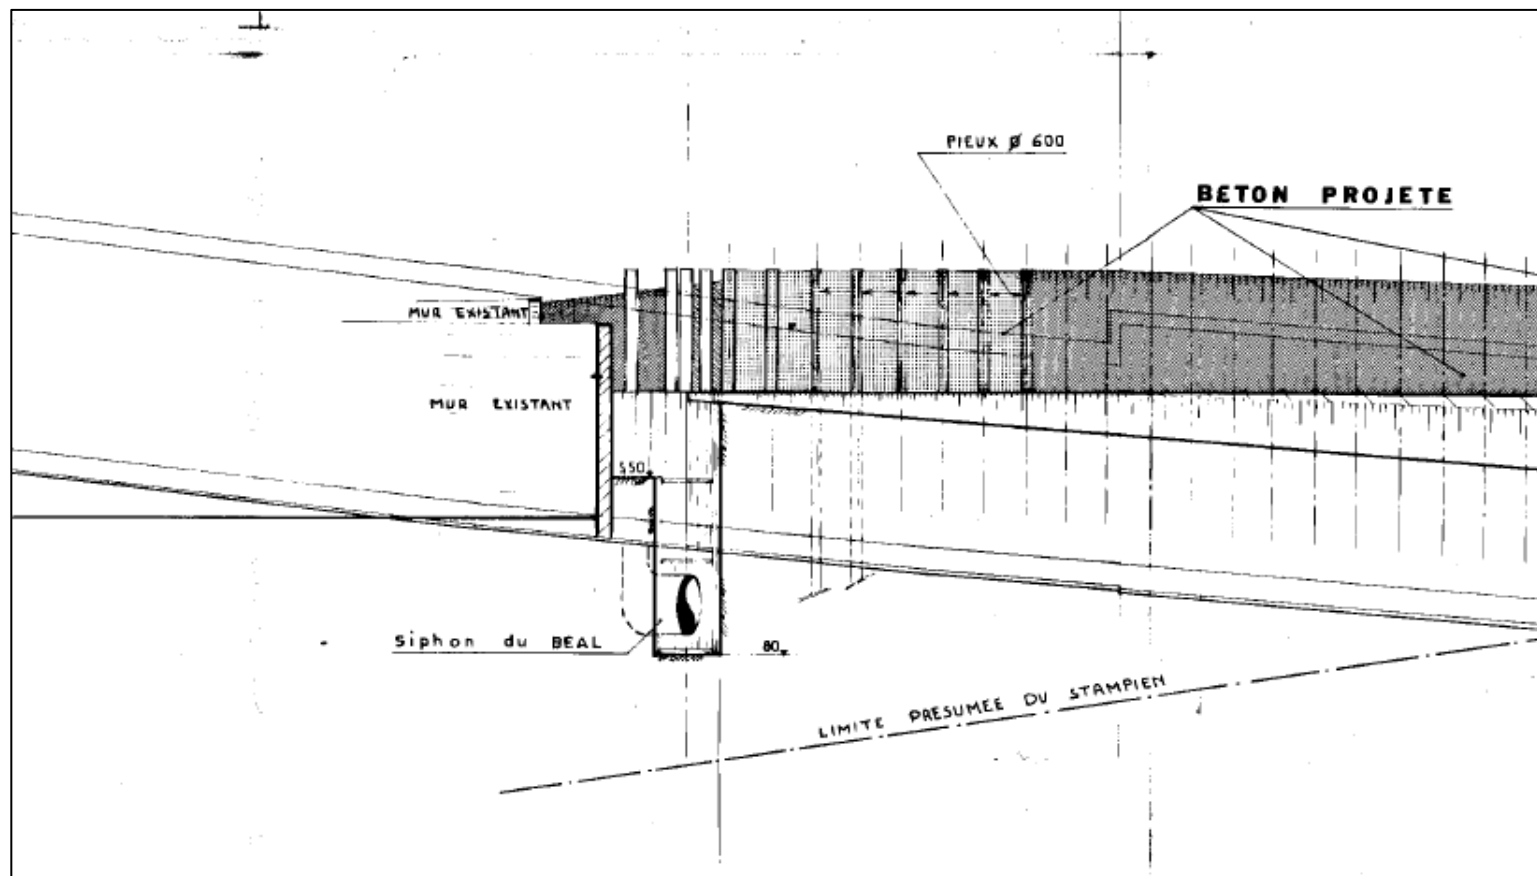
Extrait plan 15/41^A du 15/08/1984 – Dossier OUVRAGE RTM
